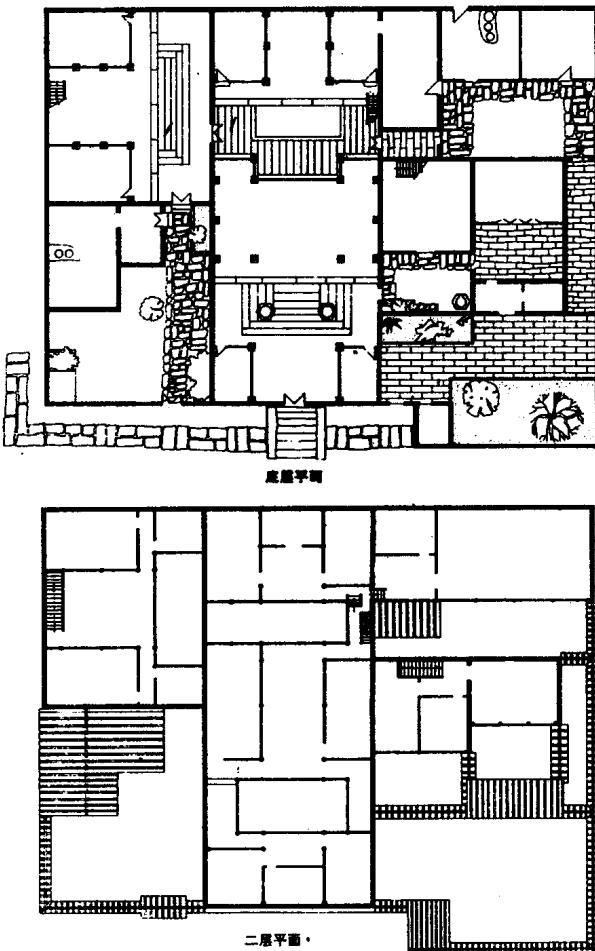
同为建筑平面图，上面是房屋的底层平面图，明显呈现出建筑的痕迹，下面是二层平面图，已接近版面设计的特征了。
